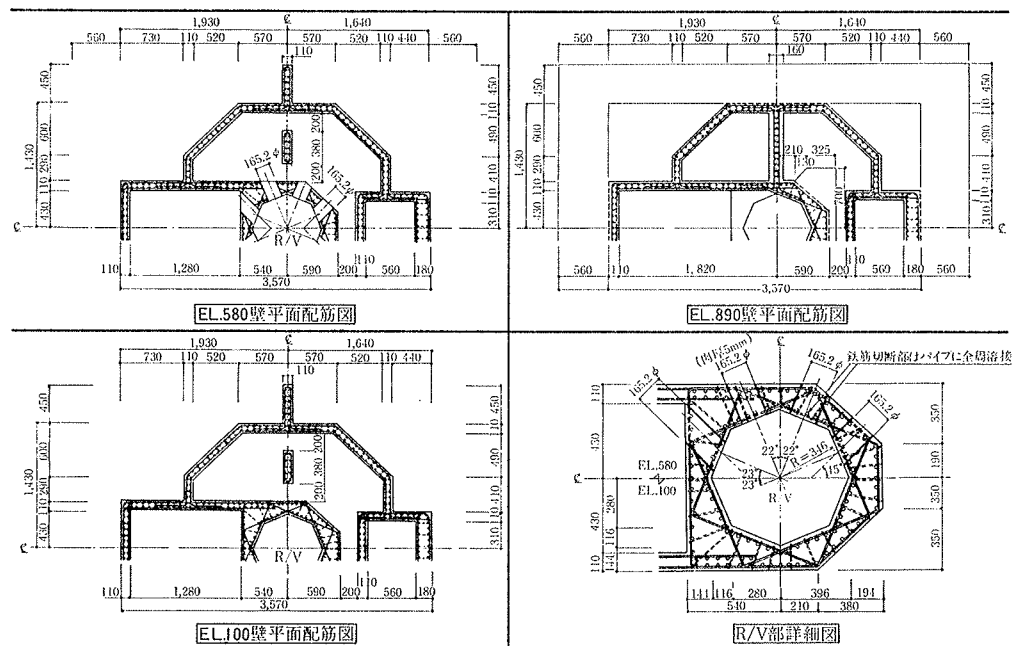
試験体主要部の平面および配筋図<sup>1)</sup>
